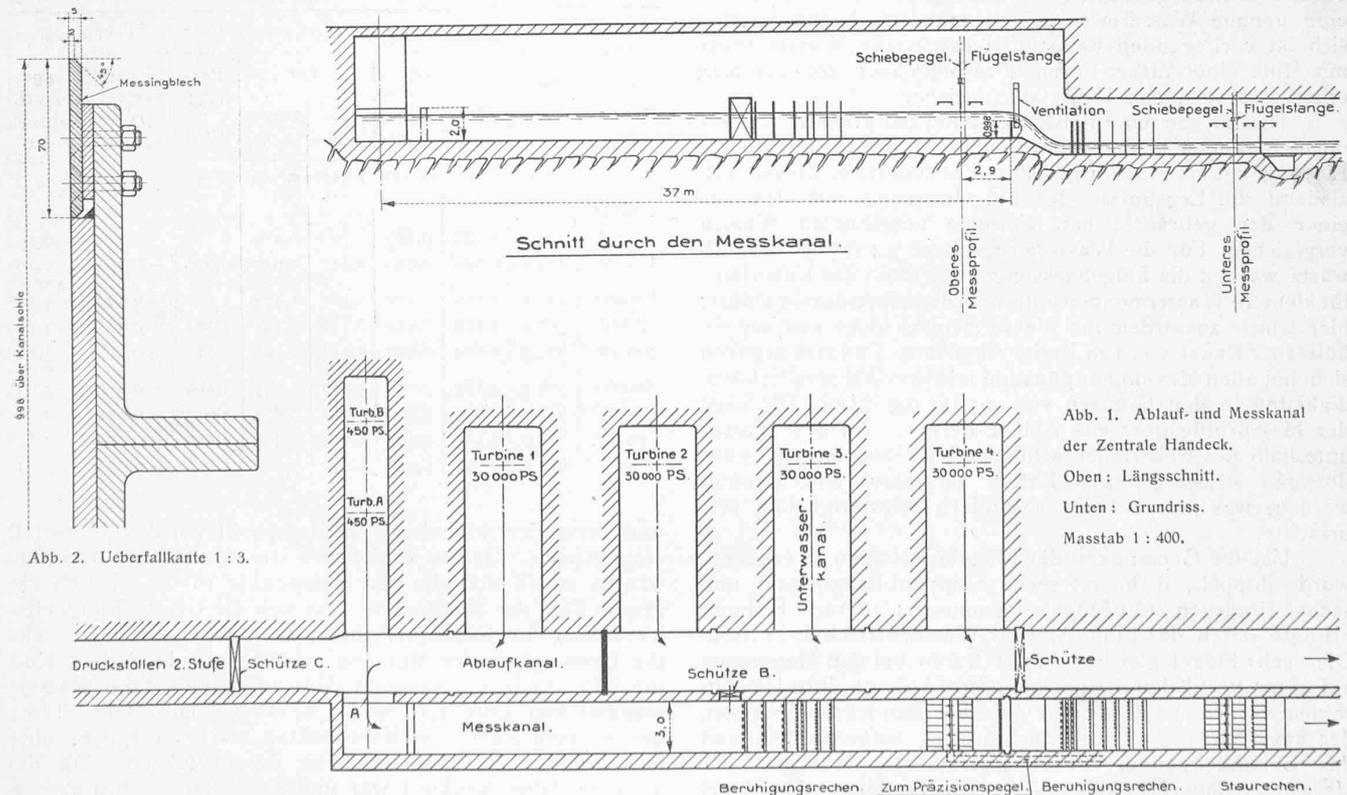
Ablauf- und Messkanal der Zentrale Handeck. Oben: Längsschnitt. Unten: Grundriss. Masstab 1 : 400.
